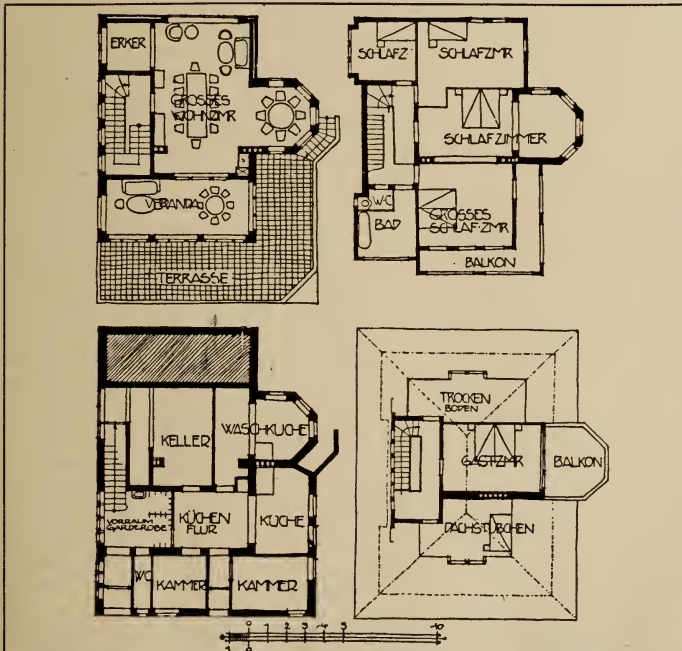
43. Sommerhaus am Meeresstrande. Erdgeschoß, Obergeschoß, Kellergeschoß und Dachgeschoß
